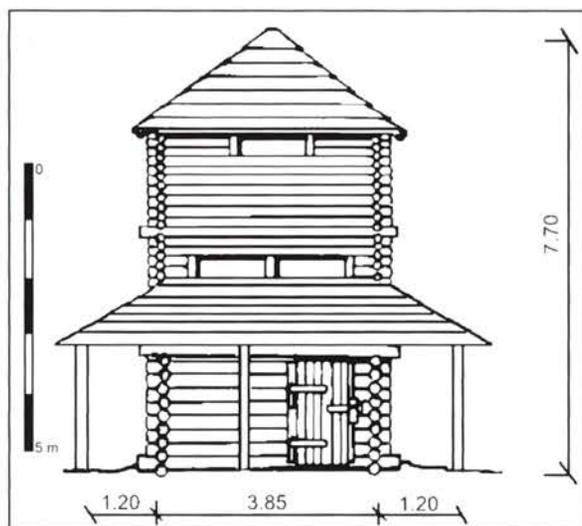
Ducové. Bau 2. Rekonstruktionsversuch (H. Albrecht – A. Ruttkay).
